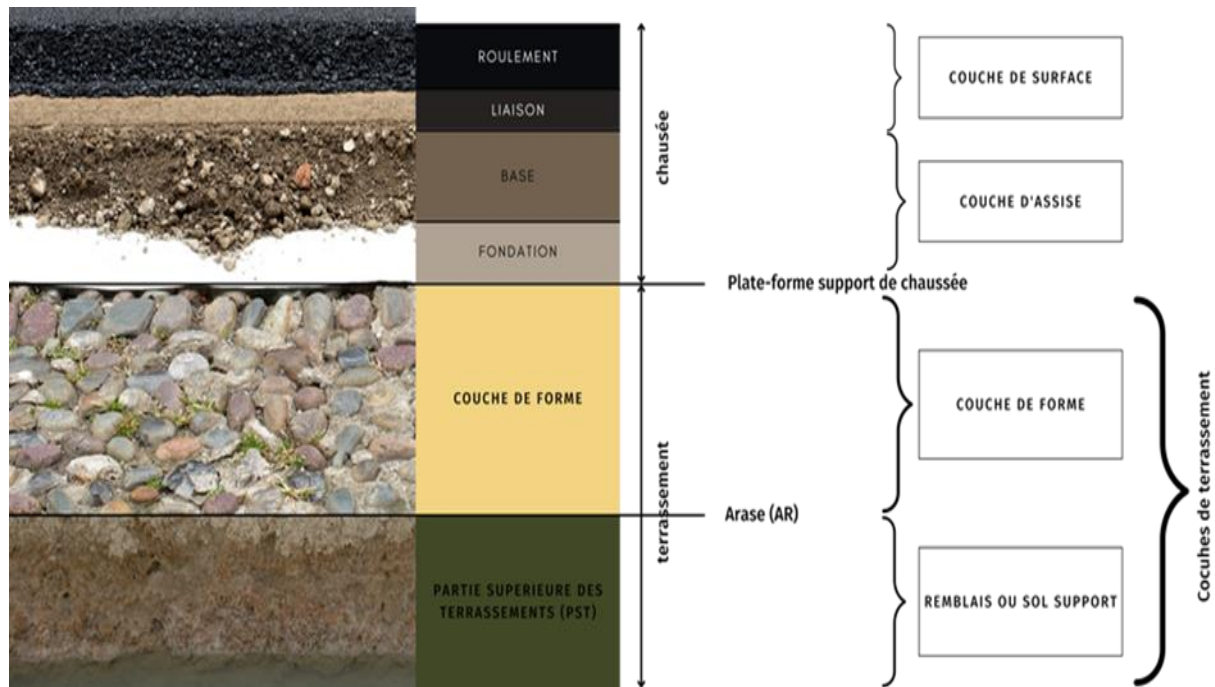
Les différentes couches de chaussée (Ordener,2023)
